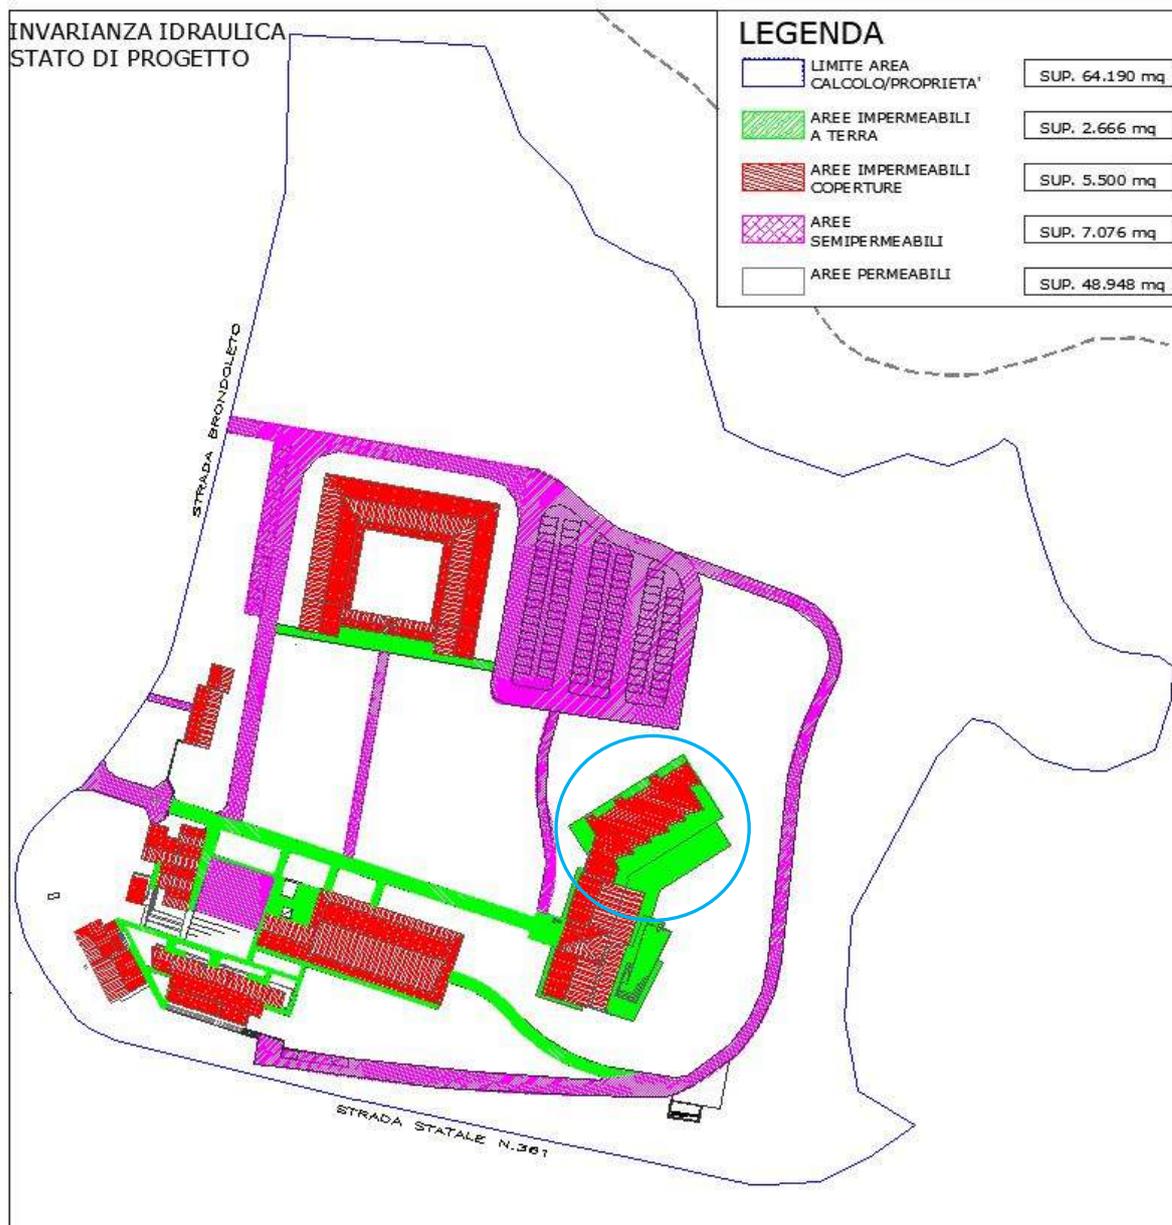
planimetria non in scala con evidenziata l'area di proprietà Deltafin e le aree impermeabili semipermeabili e permeabili conseguenti all'attuazione delle opere in progetto (cerchio celeste).
